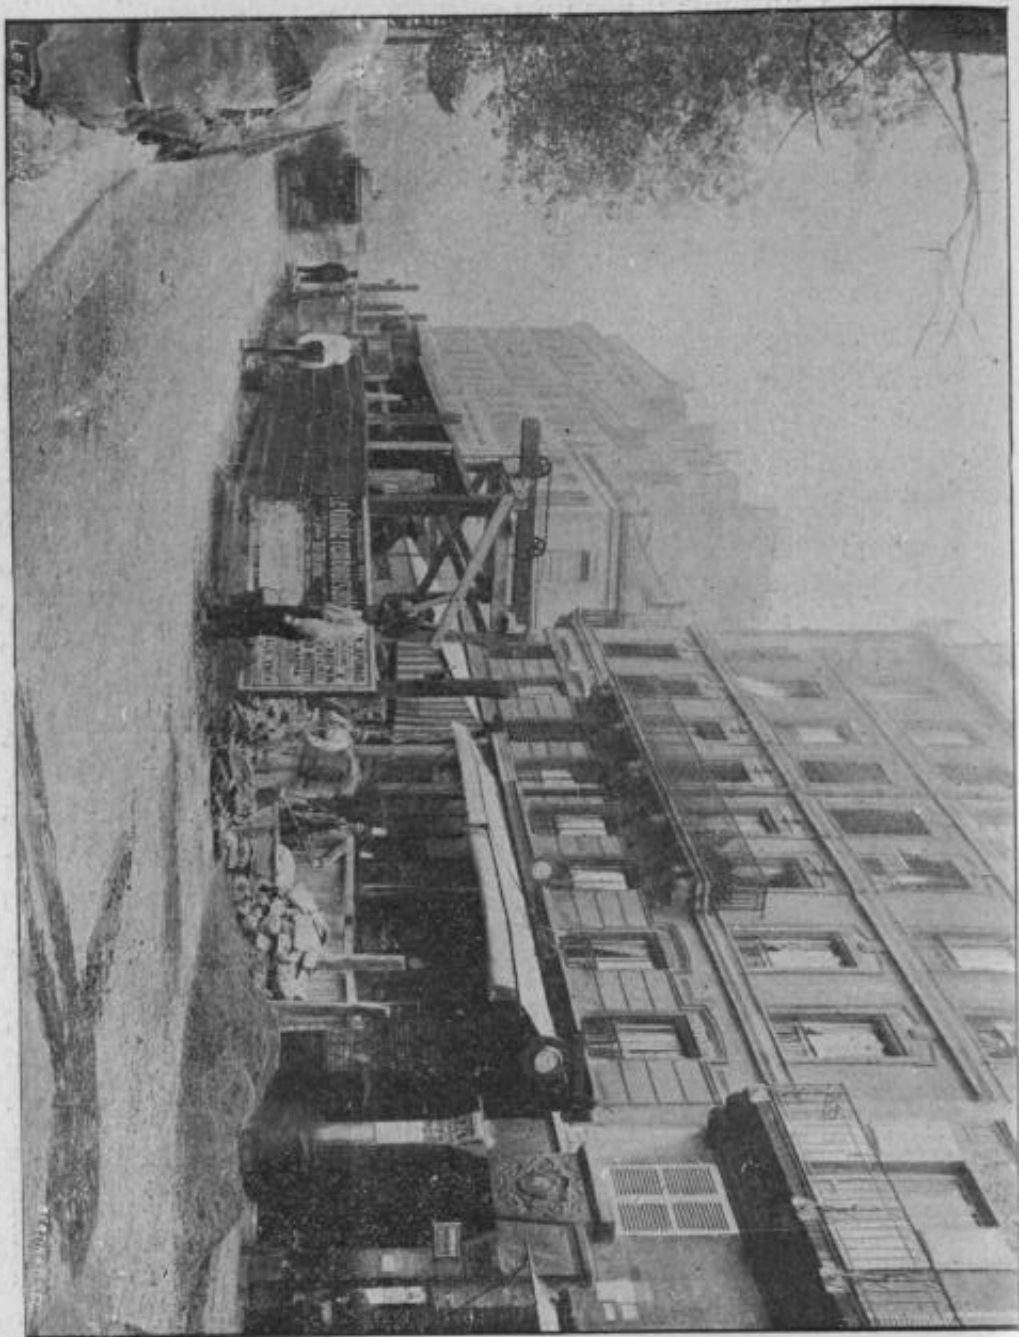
Construction d'un nouvel égout collecteur sous le boulevard de Clichy :
